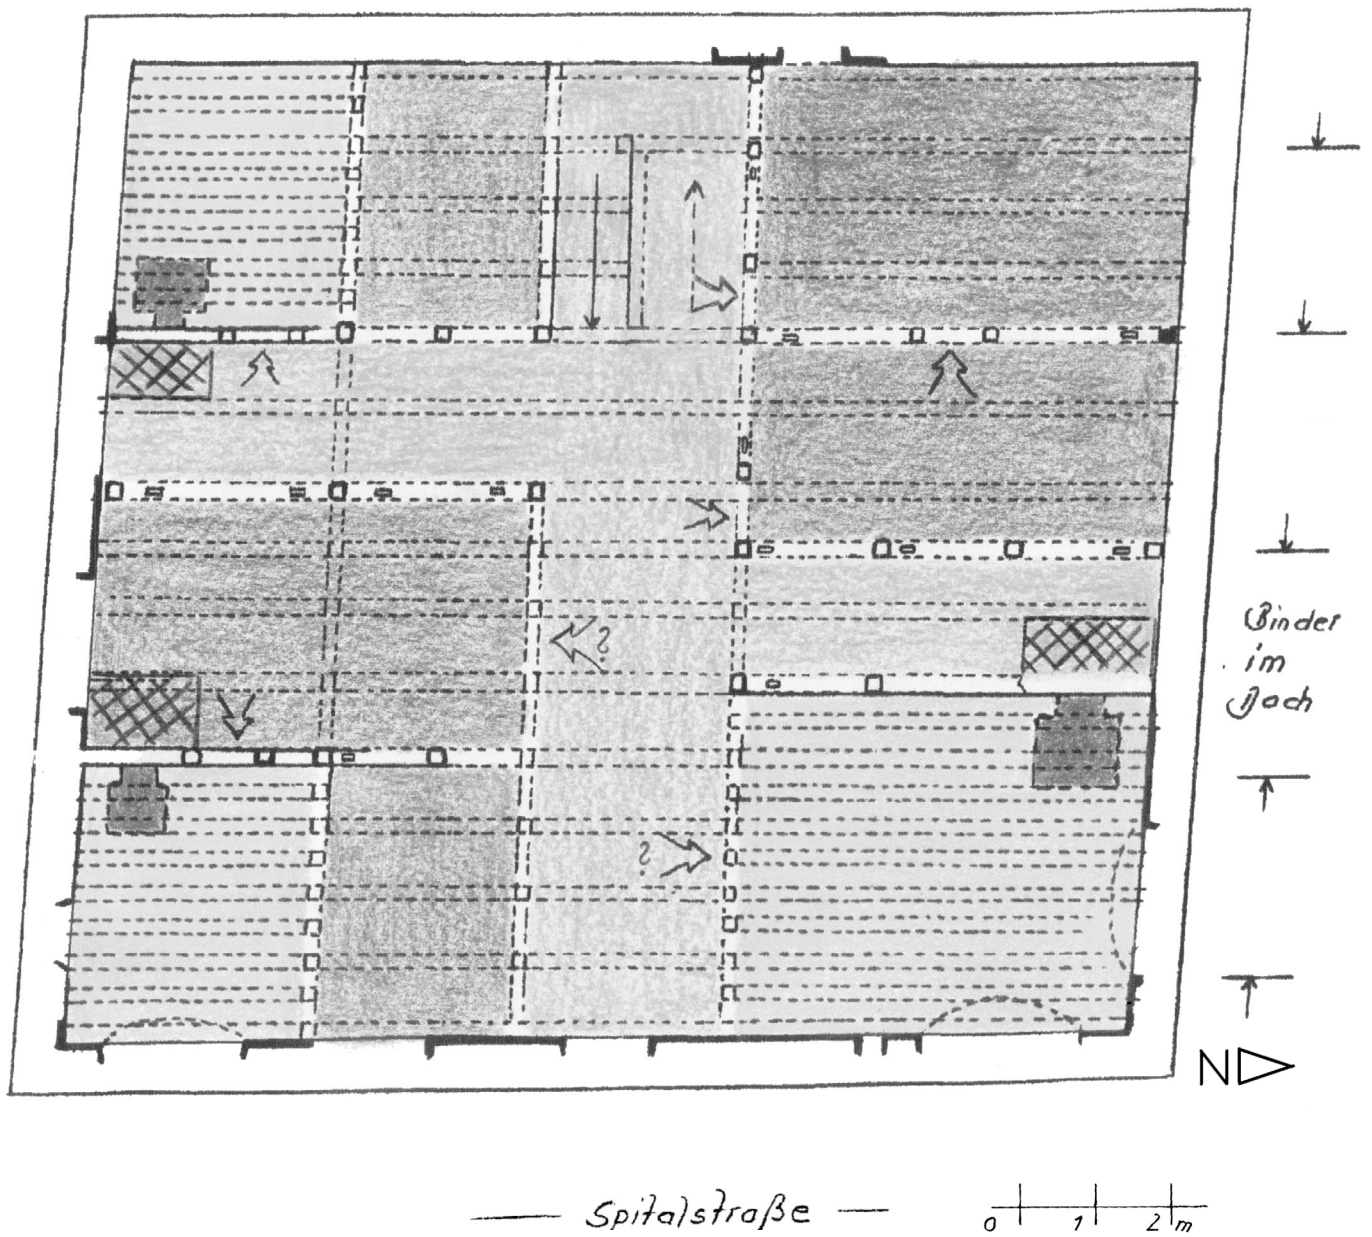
Spitalstraße 33, Grundriss 1. Obergeschoss mit beheizbaren Stuben, um 1580 (d), Rekonstruktion.
